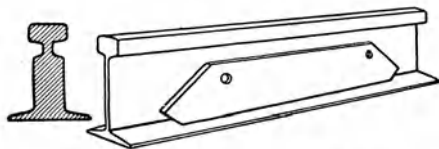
Im Lichtbogen geschweißte Stoßverbindung.
